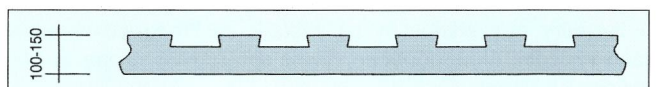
Protihlukový, dutinový panel – příčný řez / hollow core panel with sound absorbing layer – cross-section
